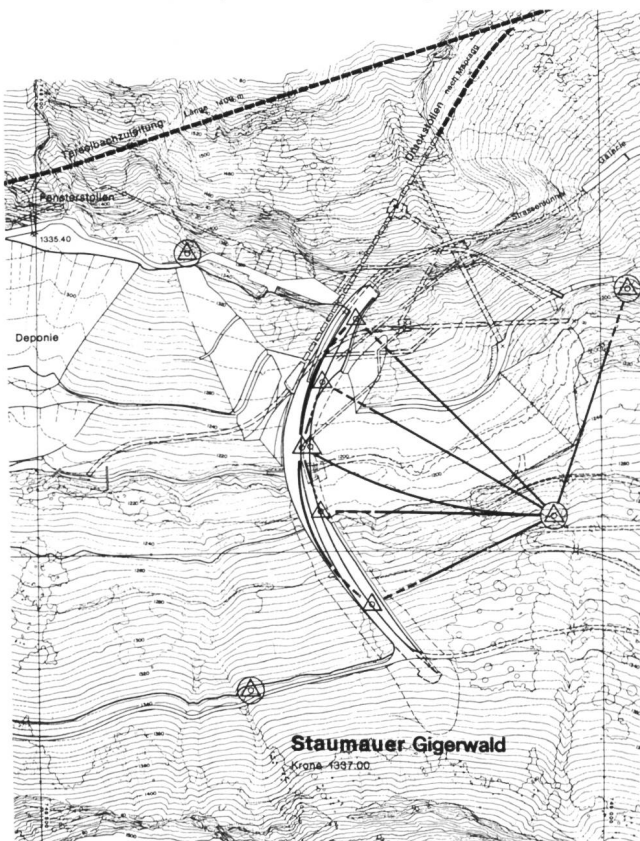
Lageplan der Staumauer Gigerwald, Massstab 1:7000. Eingezeichnet ist das Triangulationsnetz mit Mekometereinsatz, Netzplan einer Vollmessung. Die Dreiecke bezeichnen die Beobachtungspfeiler, die eingekreisten Dreiecke bezeichnen Beobachtungspfeiler ausserhalb der Staumauer, diejenigen ohne Kreise solche auf der Staumauer.
